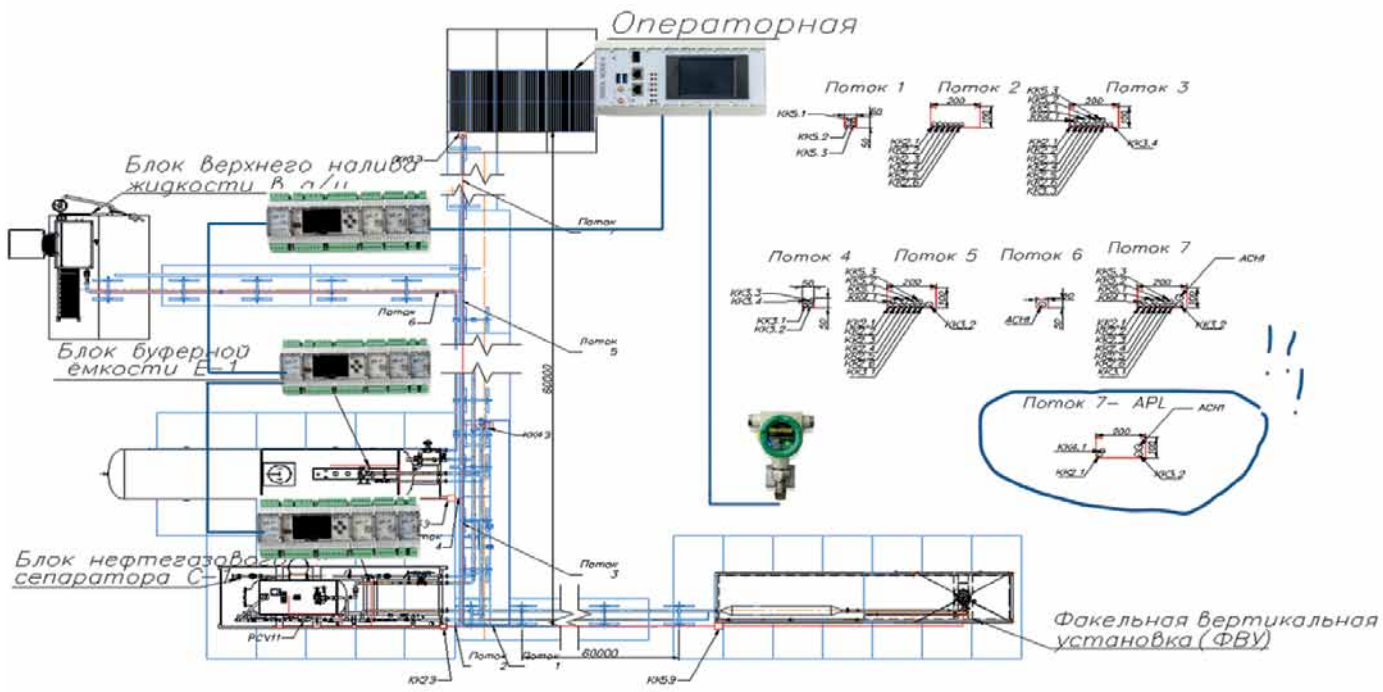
Соотношение базового кабельного потока и этого же кабельного потока на базе решения APL
